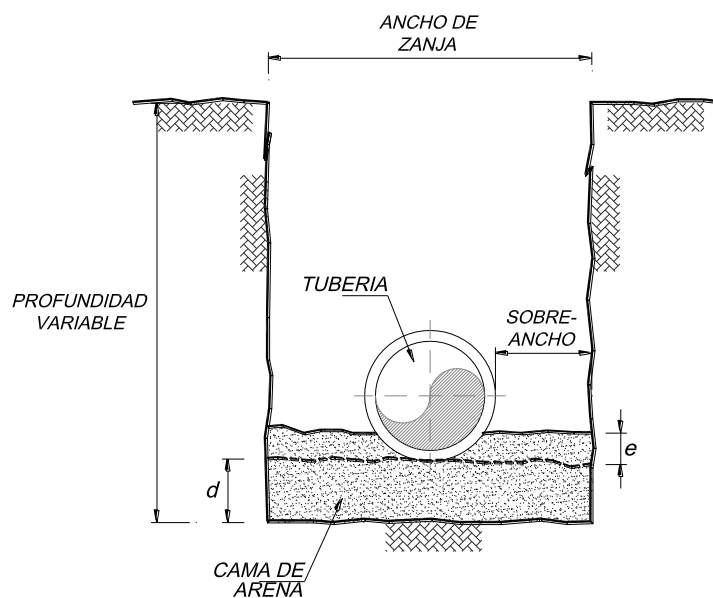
Esquema de la geometría de excavación de zanjas (*)
